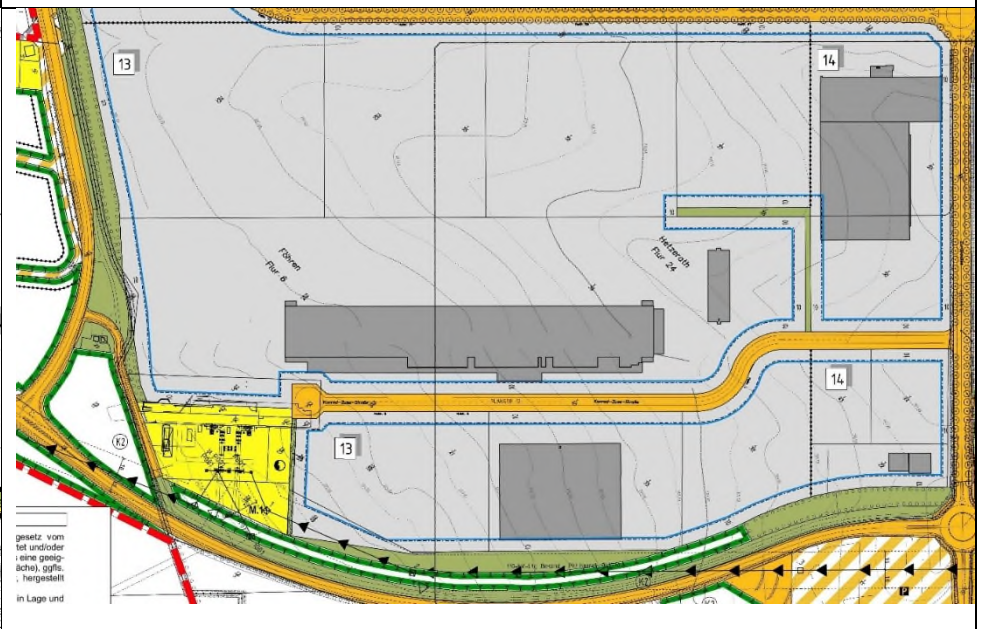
M 1 - Ausschnitt B-Plan i.d.F der 9. Änderung (unmaßstäblich)
